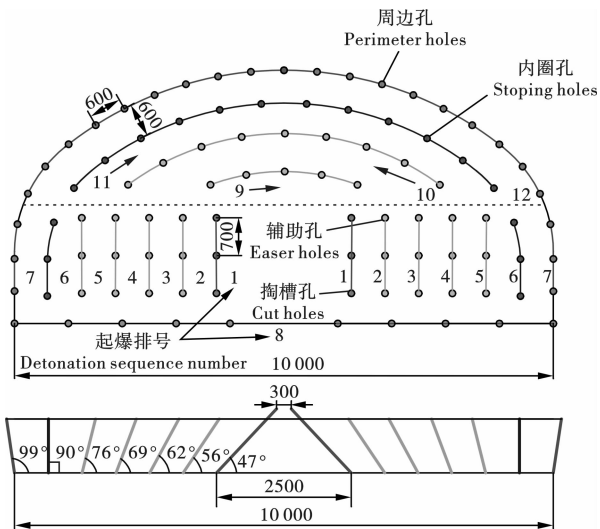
S形起爆炮孔布置图及起爆顺序(单位:mm)
